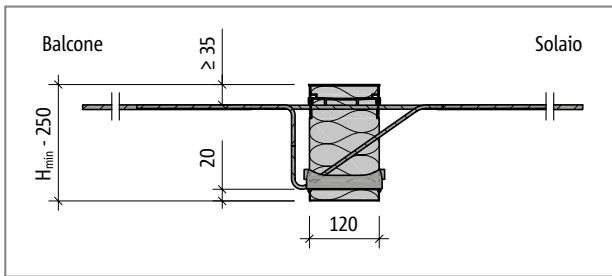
Schöck Isokorb® tipo KXT15 – KXT40: sezione dell'elemento
